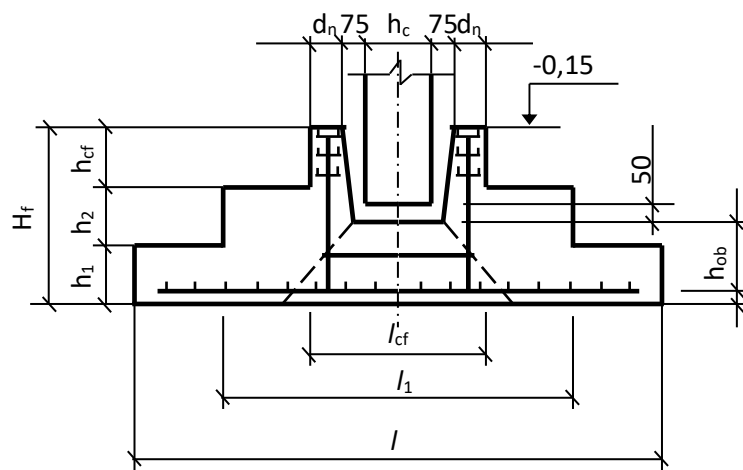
Конструкція фундаменту під збірну колону без підколонника
